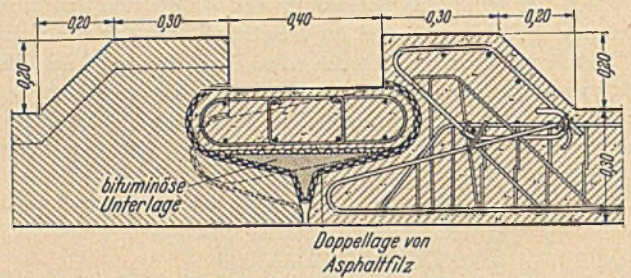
Bakhada-Staudamm. Fugenausbildung der Eisenbetondichtungsdecke.
